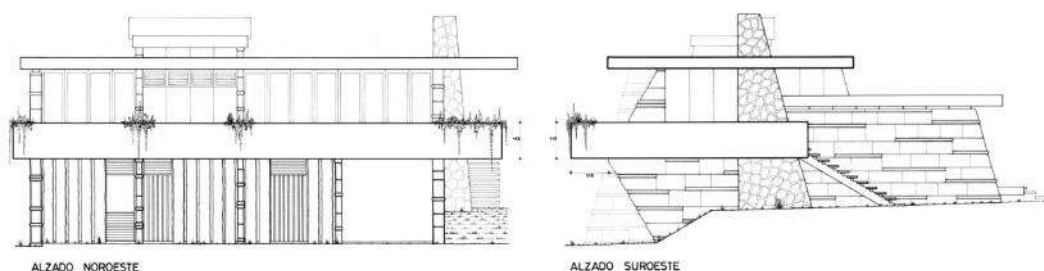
y 10. Casa Vázquez. Alzados Noroeste y Suroeste. Plano 2. Redibujado en 1987. (Archivo X.B.B: Proyecto nº 57).
